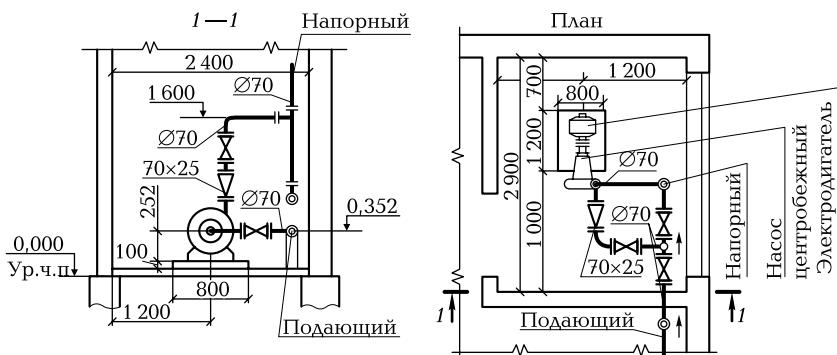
Разрез и план помещения насосной установки для повышения напора в системе отопления многоэтажного здания
